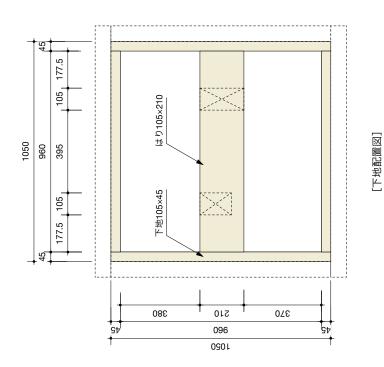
試験体 3-2 壁-床取合い部 割付図
